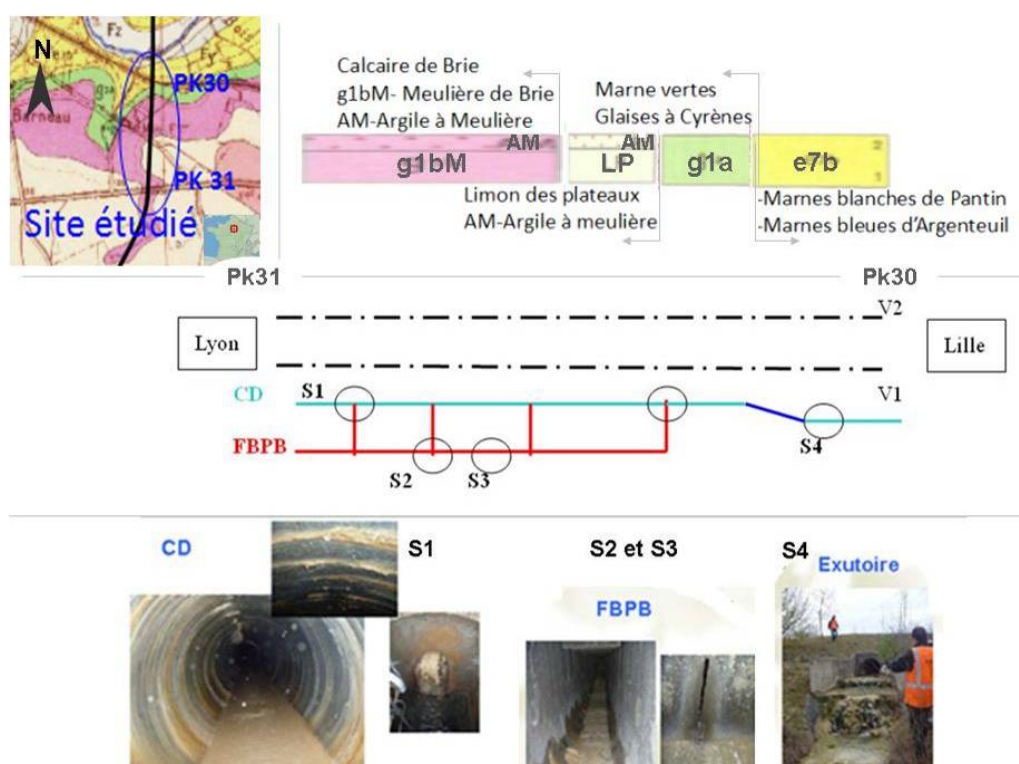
Schéma de principe du système de drainage et plan d'échantillonnage sur le site de Soignolles
